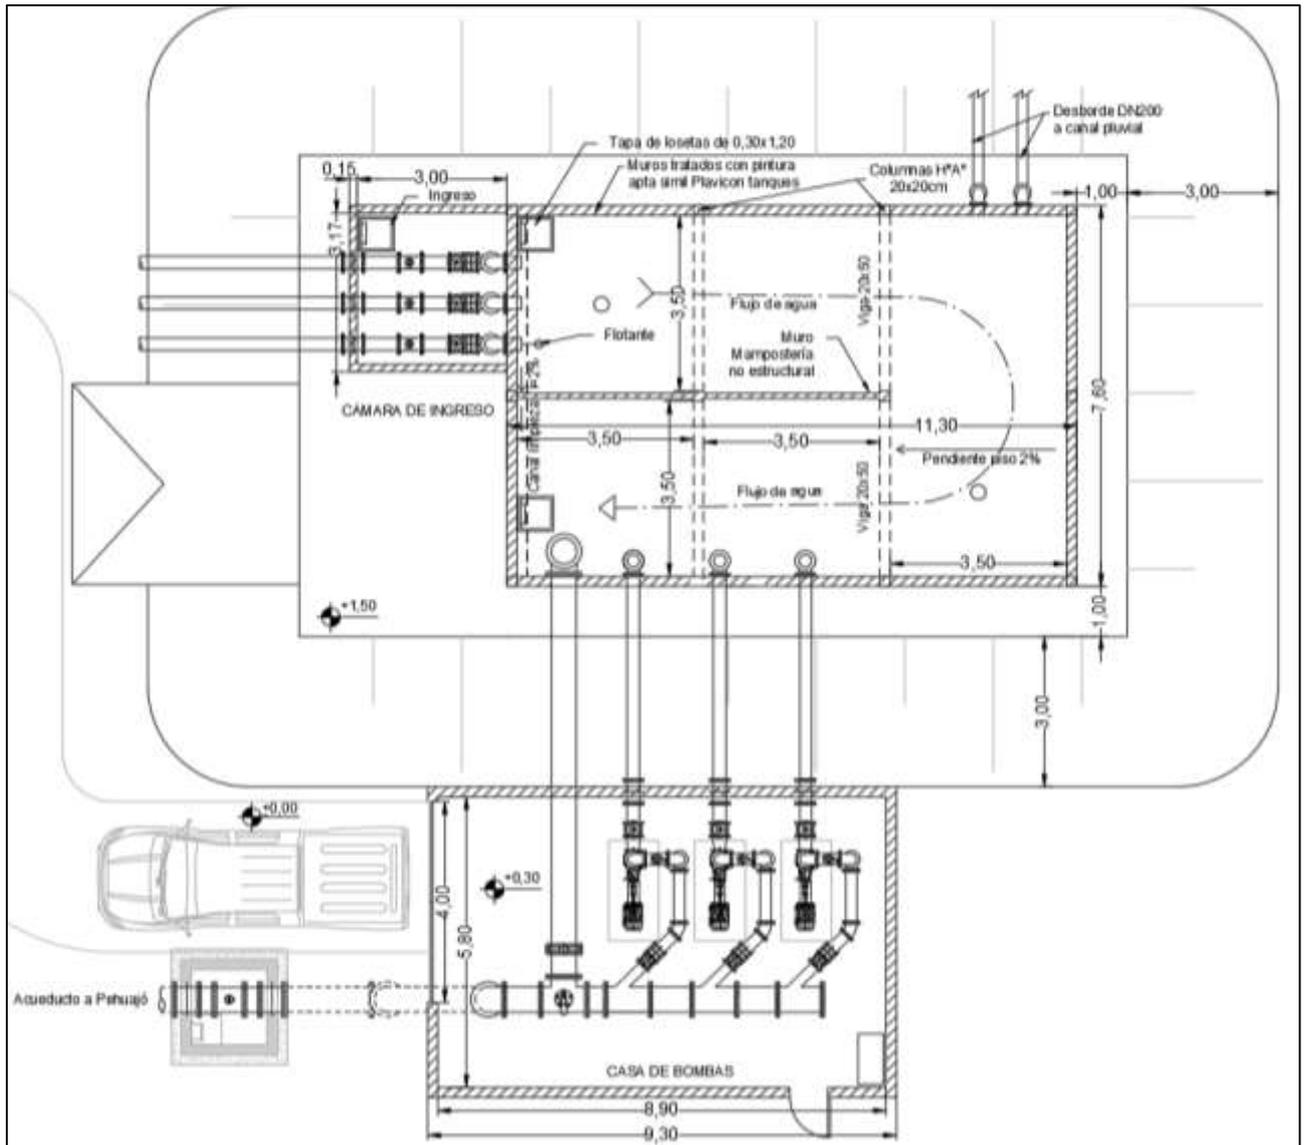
Planta de obras en cabecera (cisterna y casa de bombas)
